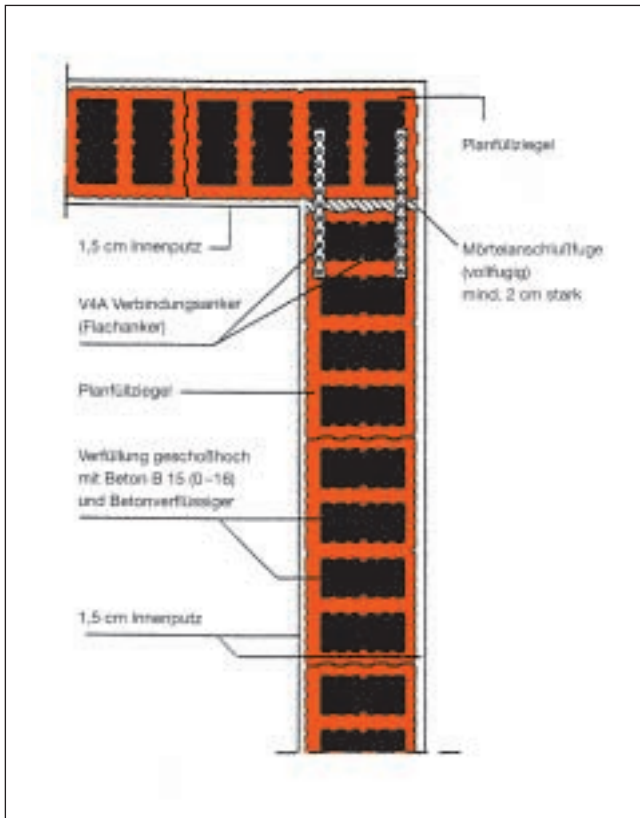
Horizontalschnitt Eckausbildung in Stumpfstoßtechnik mit Plan-Füllziegel
